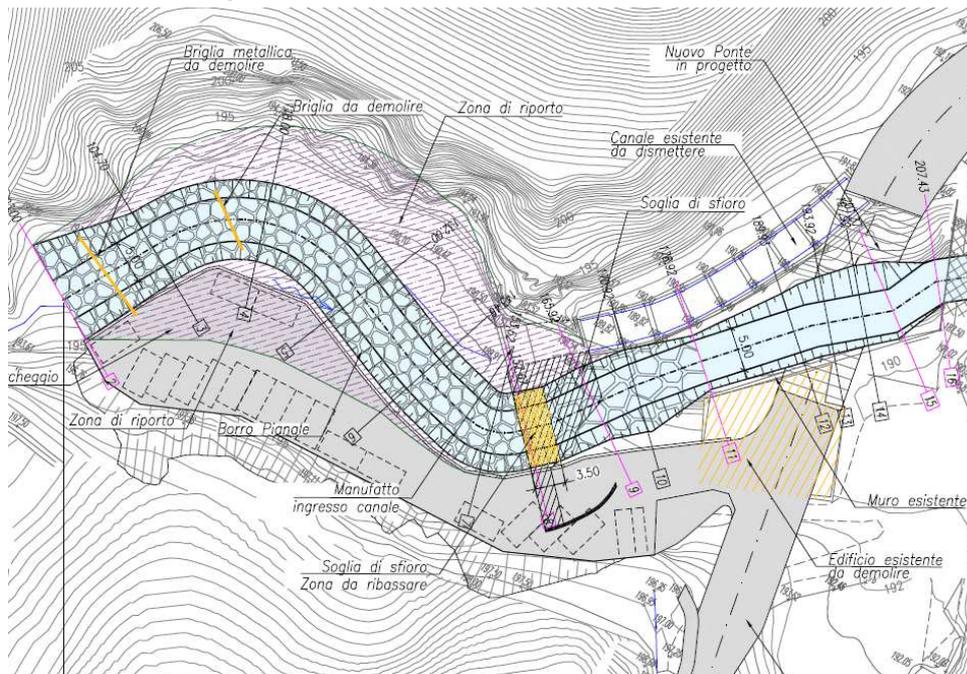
Planimetria Tavola 1/3 – Borro Pianale
